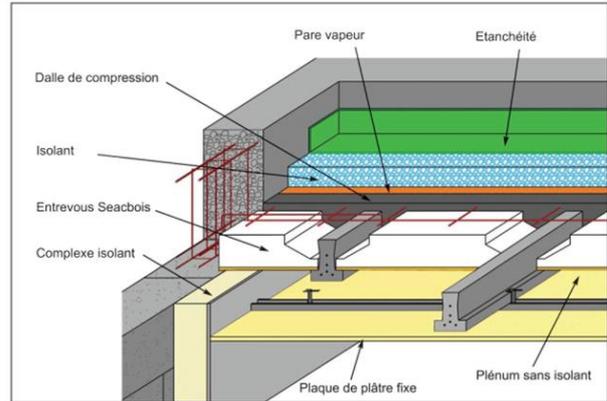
Les éléments constituant un toit terrasse et son étanchéité
